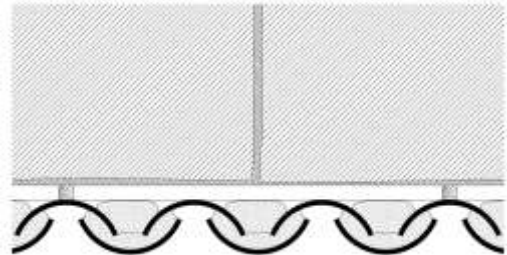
| Detalhamento construtivo de empena revestida em telha cerâmica capa-canal, com sobreposição de telhas em fiadas côncavas e convexas e sem argamassas entre as fiadas das telhas. (desenho do autor)
